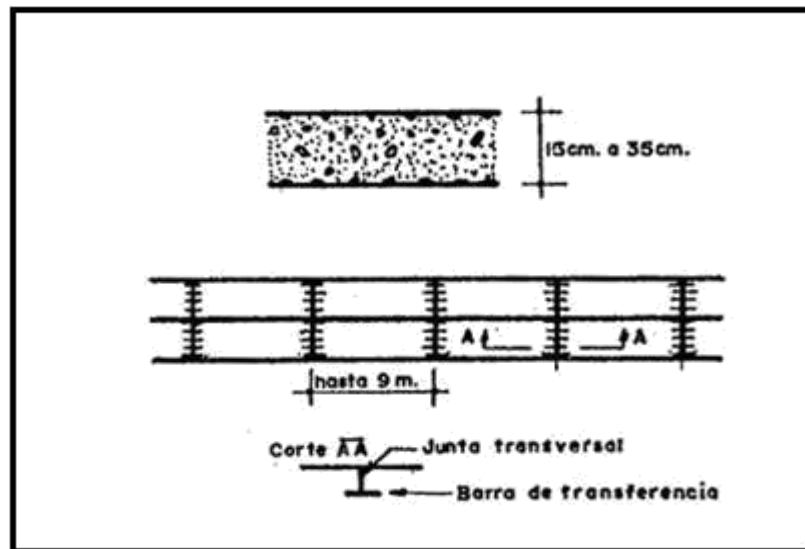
Pavimentos de Concreto Simple, con Pasadores.
